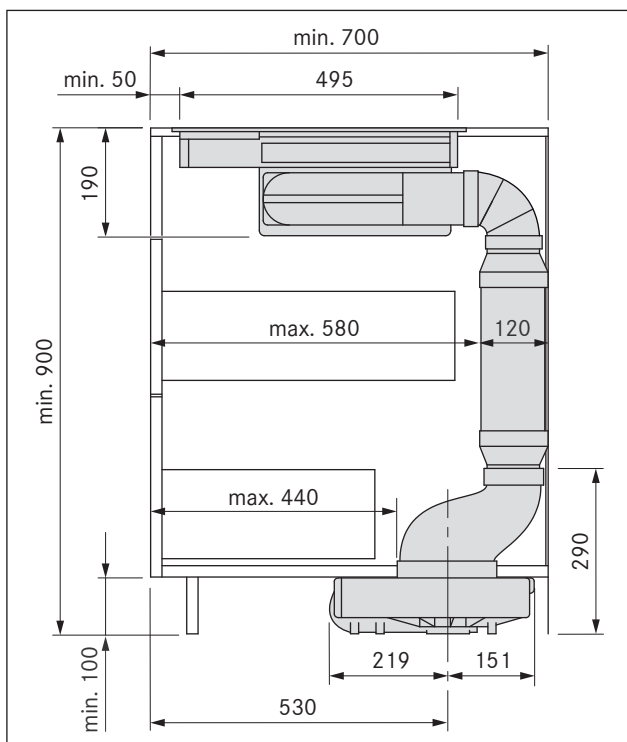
Dimensões de montagem do aparelho com silenciador plano USDF num armário com 700 mm de profundidade
